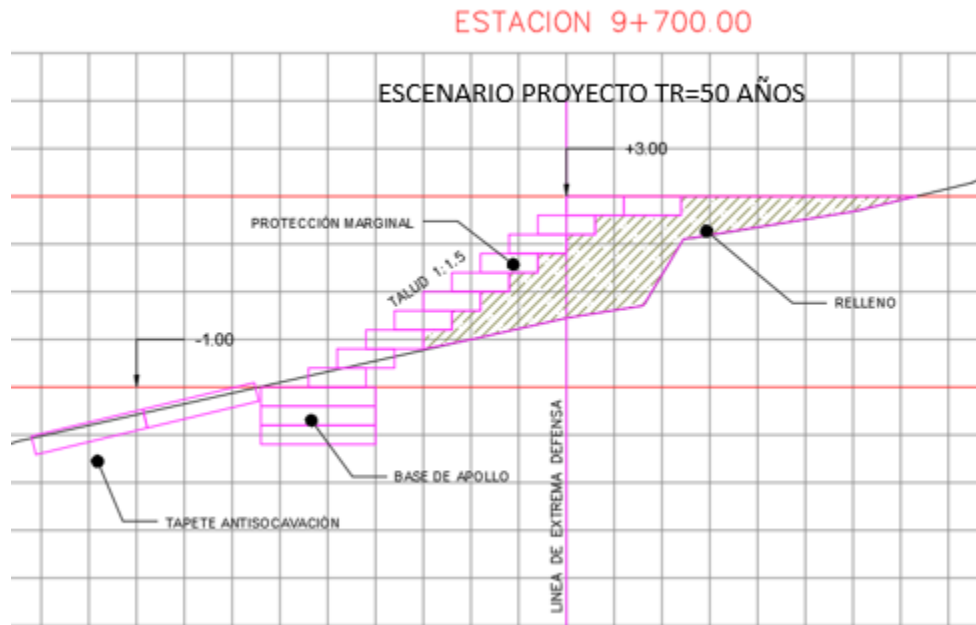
Perfil tipo de tramos donde se requiere relleno para protección a nivel de margen actual, Alternativa 02.
